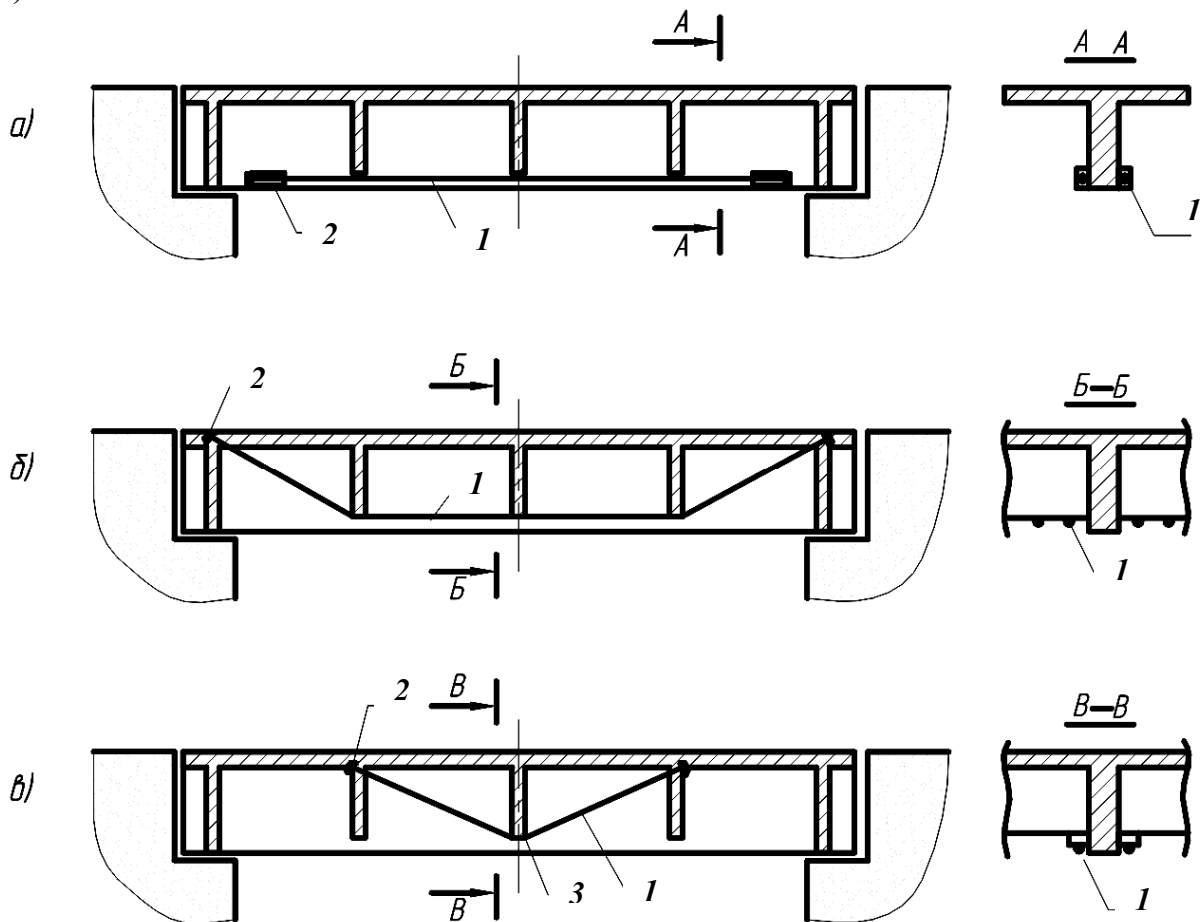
Усиление железобетонных балок путем изменения расчетной схемы применением шпренгелей: а – прямолинейный шпренгель; б - полигональный шпренгель; в - треугольный шпренгель на части длины; 1 – шпренгель; 2 – анкер; 3 – опирание шпренгеля на диафрагму
